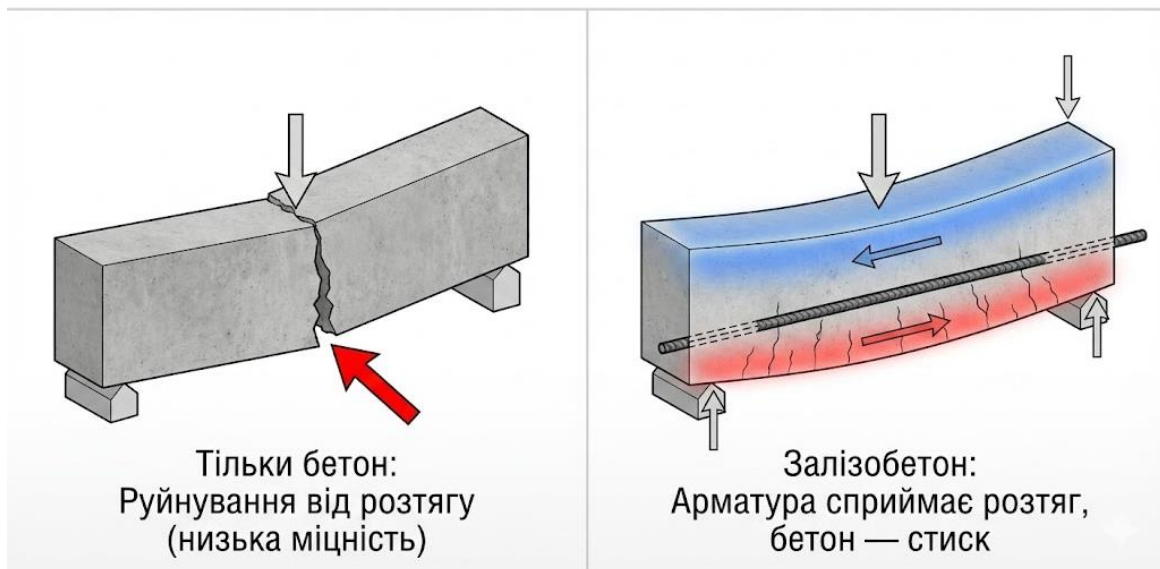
Переваги залізобетону перед звичайним бетоном
